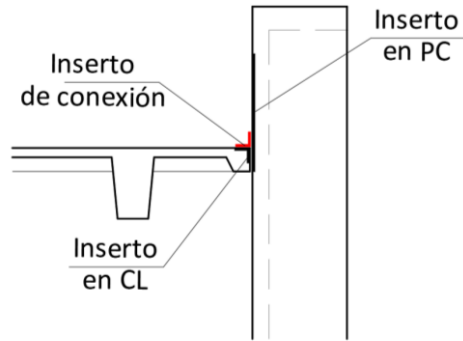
Vinculación de paneles de cubierta y paneles de cerramiento
